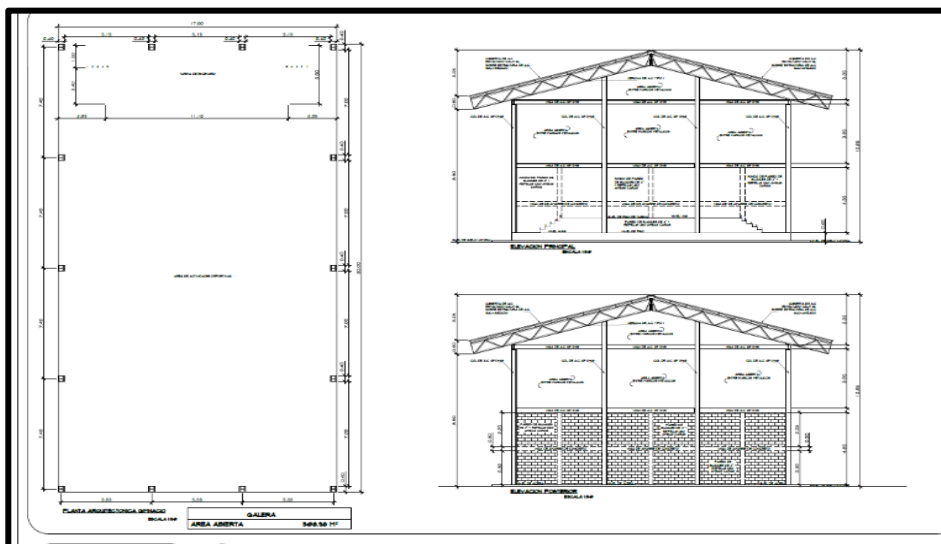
Elevación de Gimnasio y planta Arquitectónica. Fuente Anteproyecto
